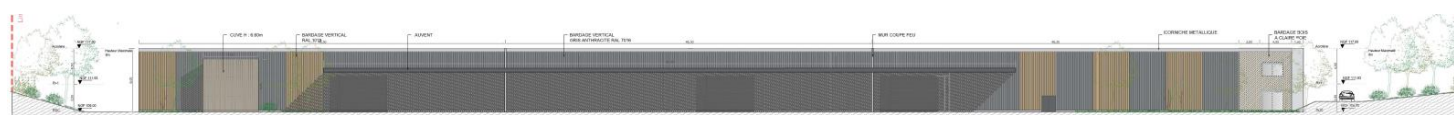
Façade Nord-ouest du bâtiment ESI, source : SPIRIT permis de construire perspective et plan de VRD
